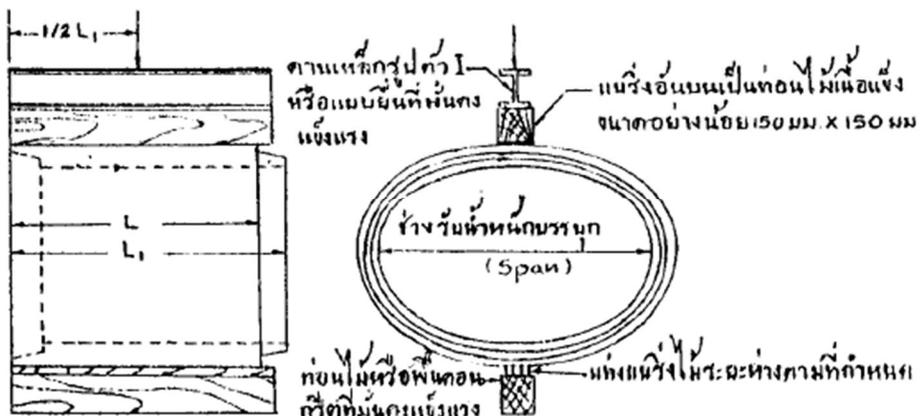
การทดลองท่อแบบปากกระฉิ่งโดยวิธี THREE-EDGE BEARINGS
